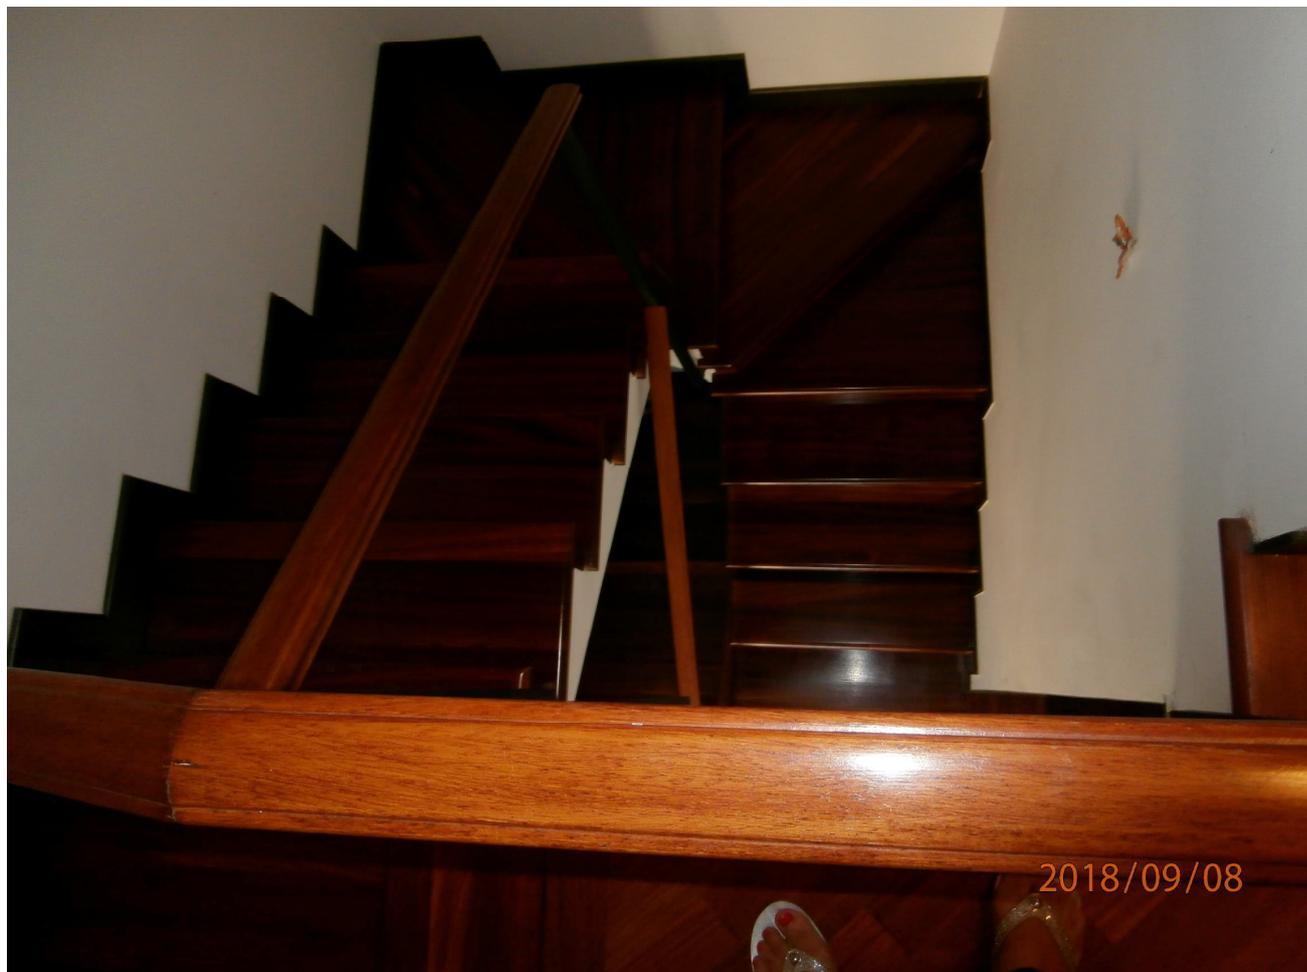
Vista della scala dal pianerottolo del secondo piano.
